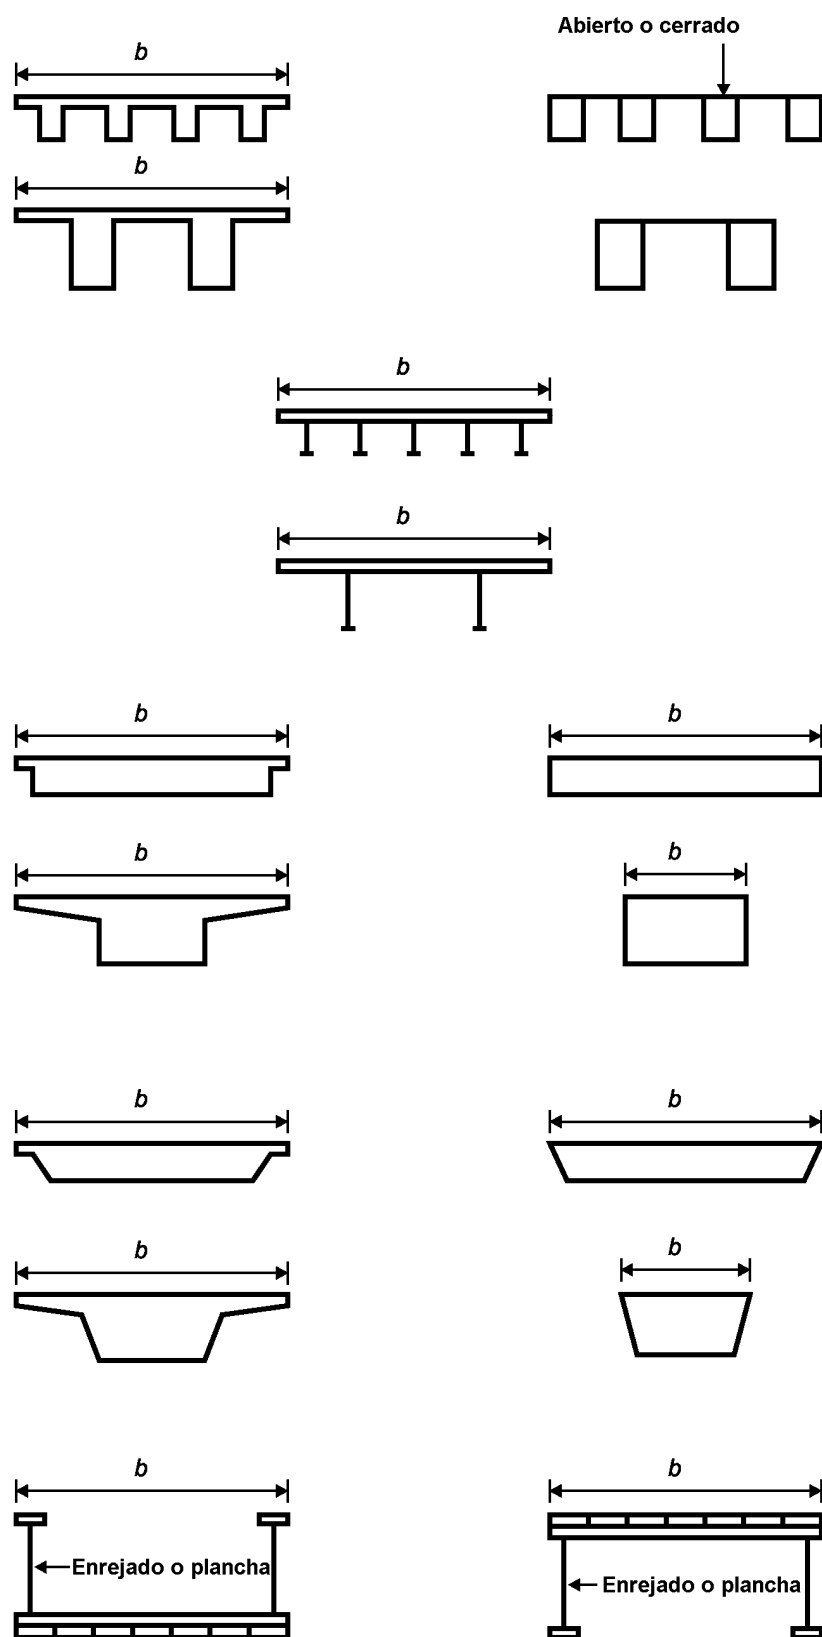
Secciones transversales comunes de tableros de puente
